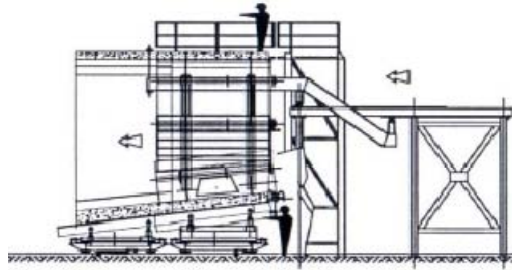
Fase 4 - Processo pré-fabricação linha curta de fabrico.
